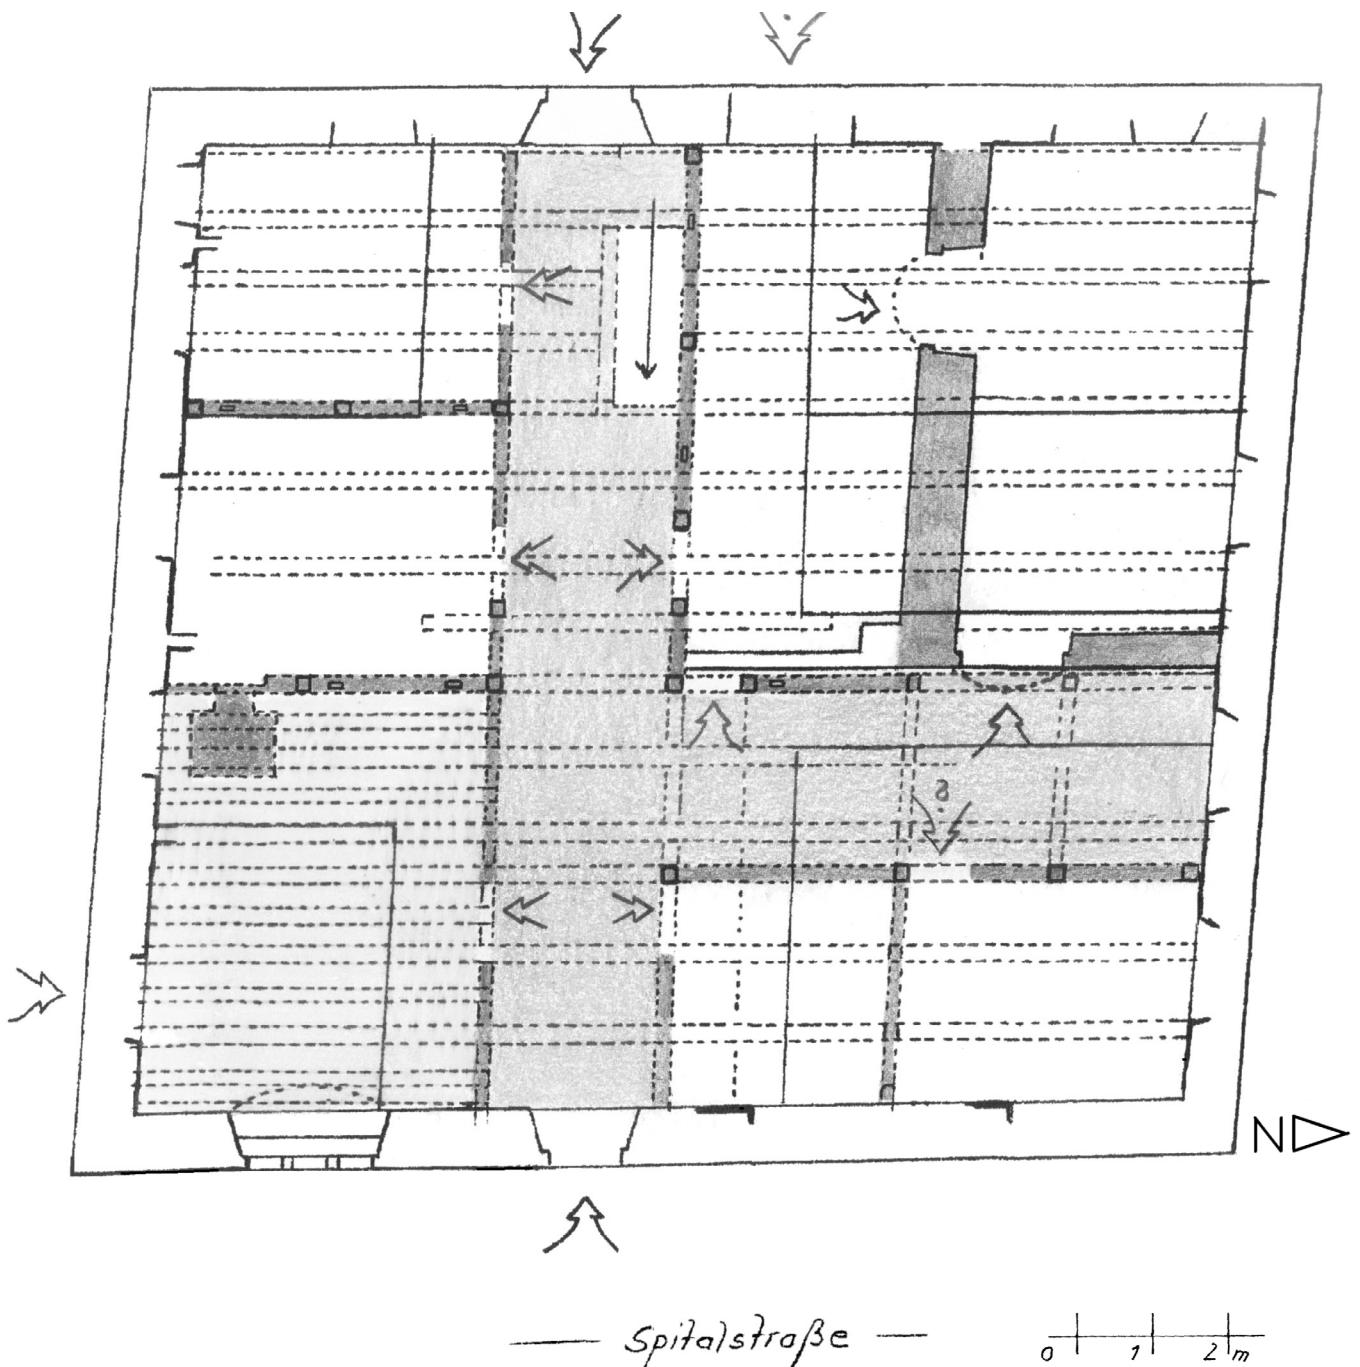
Spitalstraße 33, Grundriss Erdgeschoss, um 1580 (d), Rekonstruktion.
